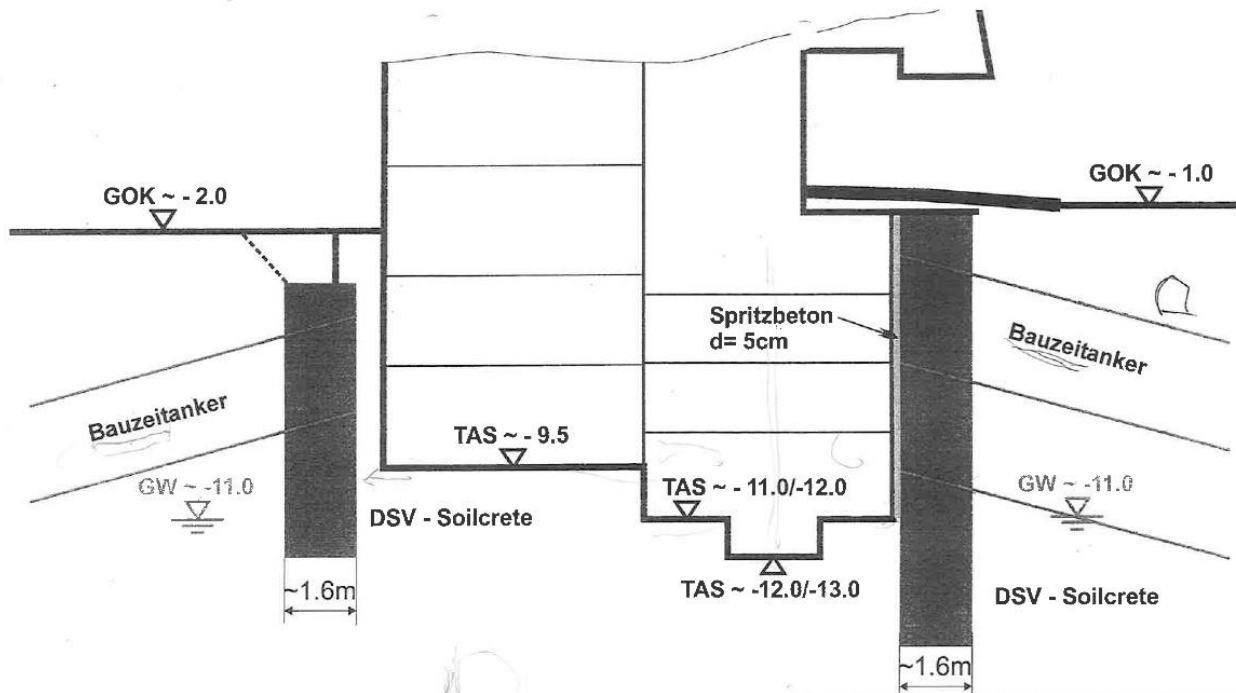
Sección con niveles de excavación y anclaje de muros pantalla
